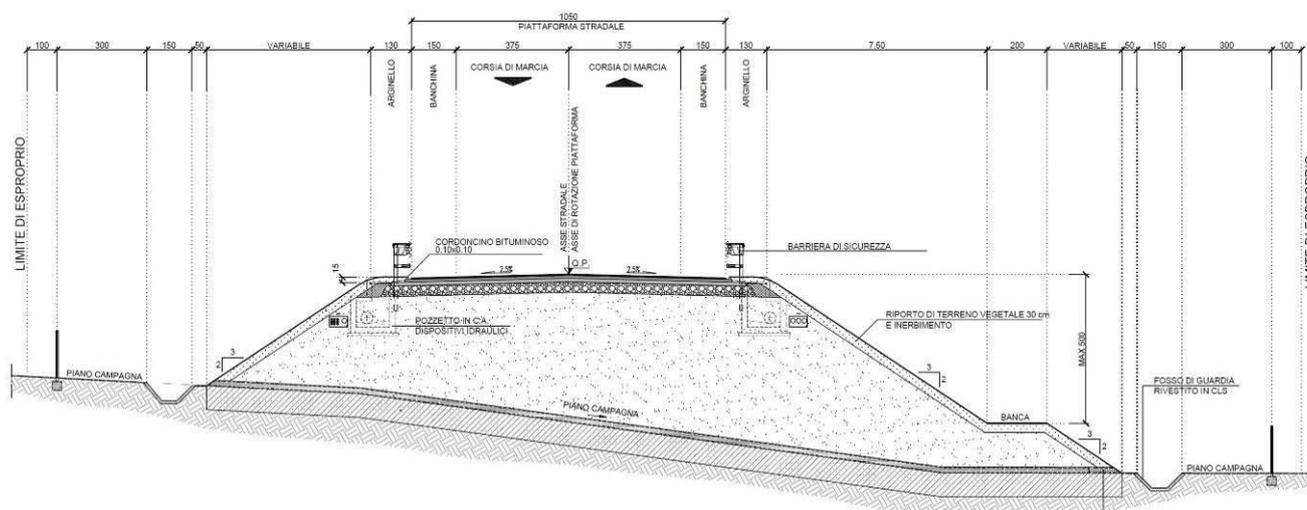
COMPOSIZIONE DELLA SEZIONE STRADALE
